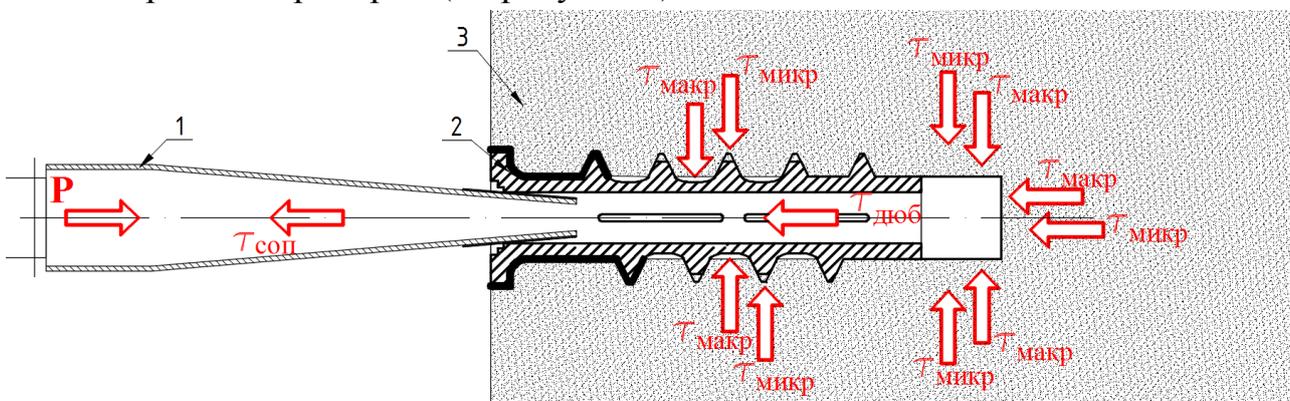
Физическая модель движения клеевой композиции при устройстве анкеров методом нагнетания. Поперечный разрез, фрагмент. 1 – сопло нагнетательной установки; 2 – установленный дюбель; 3 – газобетонный блок
